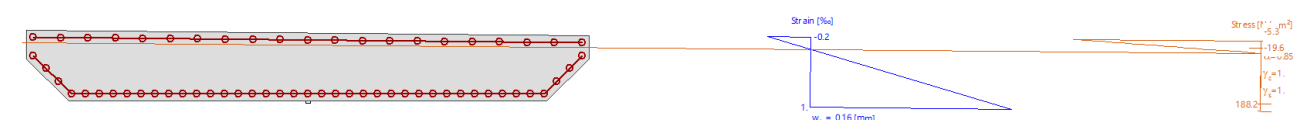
Càlcul de fissuració de secció situada al centre de llum (màxim moment positiu)
